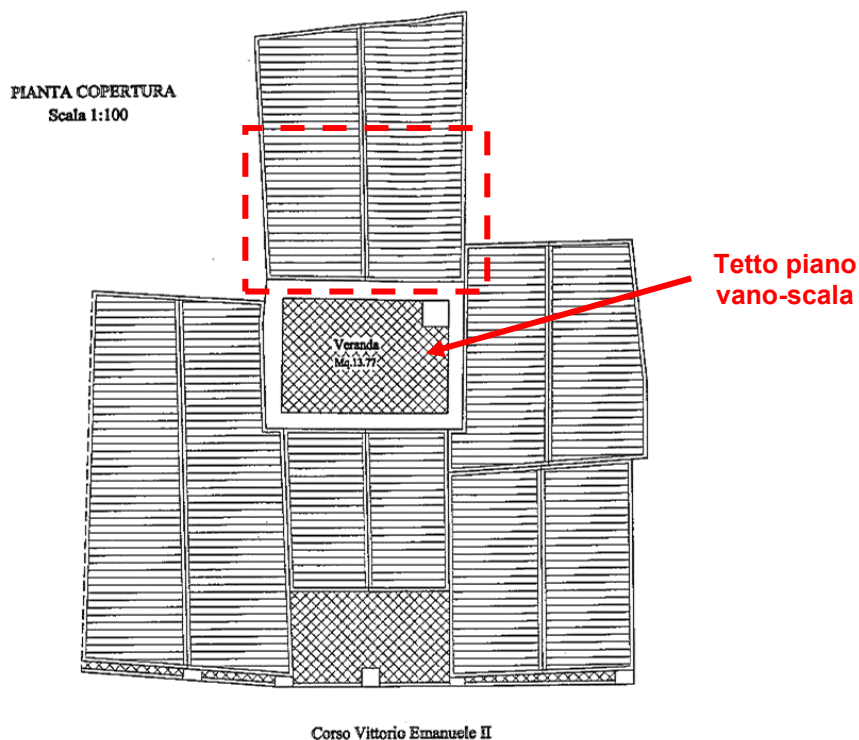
Stralcio dell'autorizzazione edilizia 93/2005. Nord in basso
